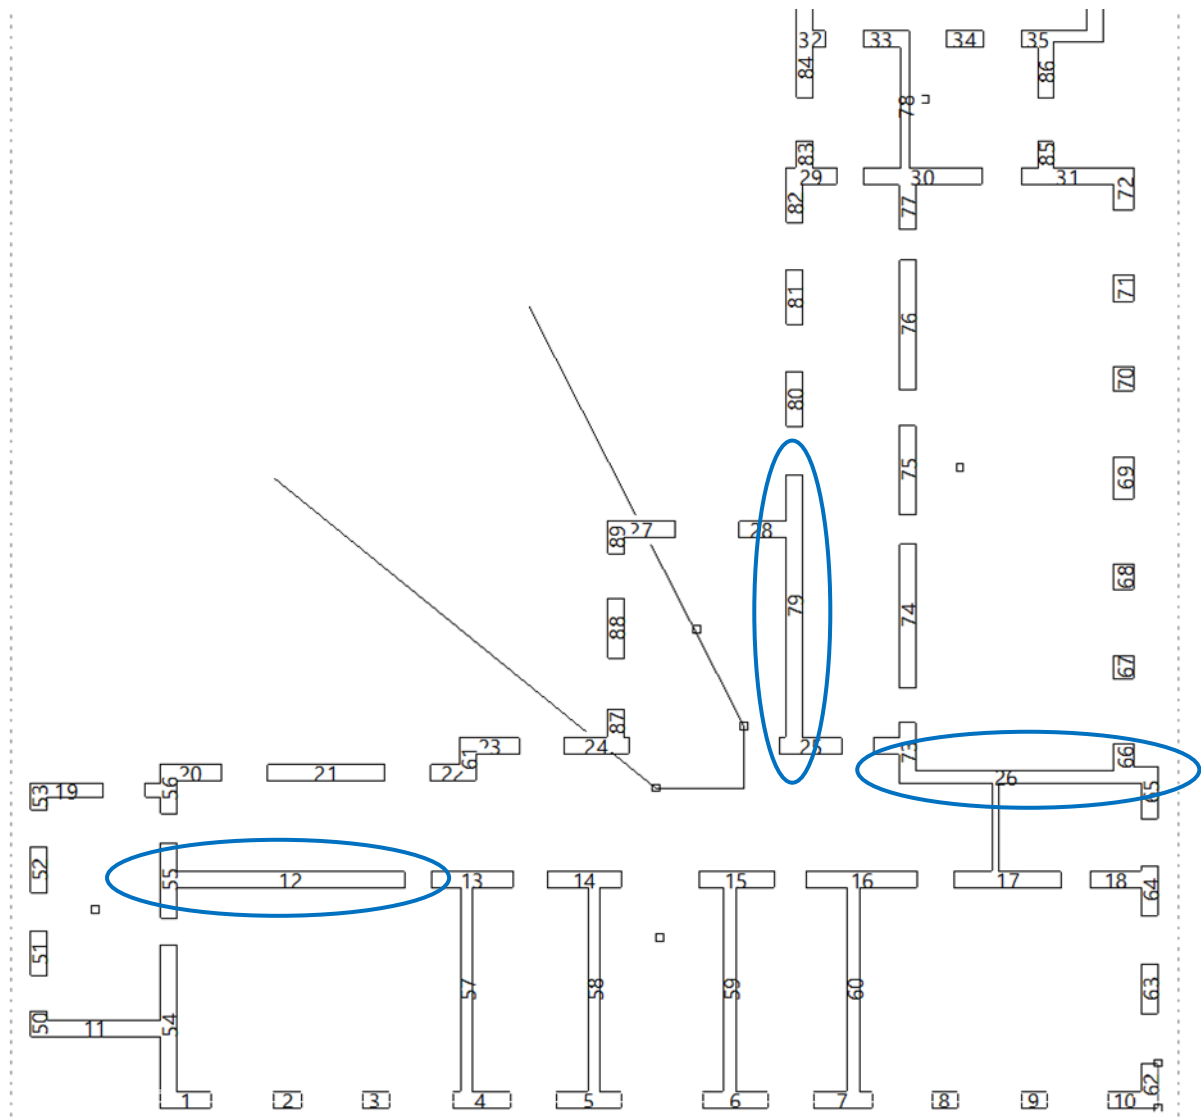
Stark belastete Wände in Handrechnung, ohne Berücksichtigung der Brüstungen.
